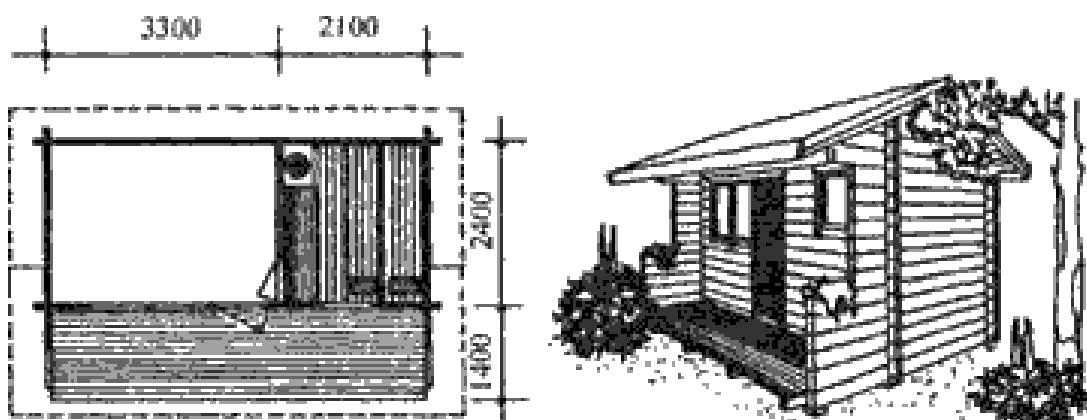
Фасад и план сауны на 4 человека с комнатой отдыха и открытым крыльцом.
